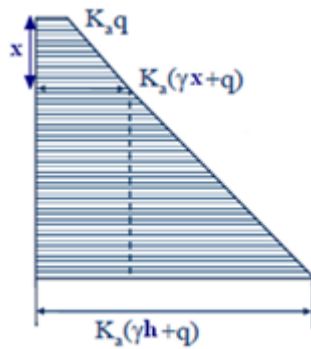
Schéma d'une poussée des terres sur la paroi d'une piscine
